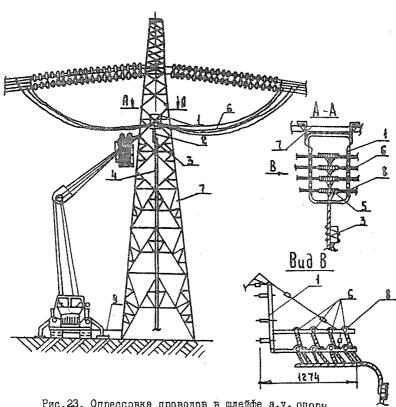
Опрессовка проводов в шлейфе а.у. опоры ВЛ 500, 750, II50 кВ:
